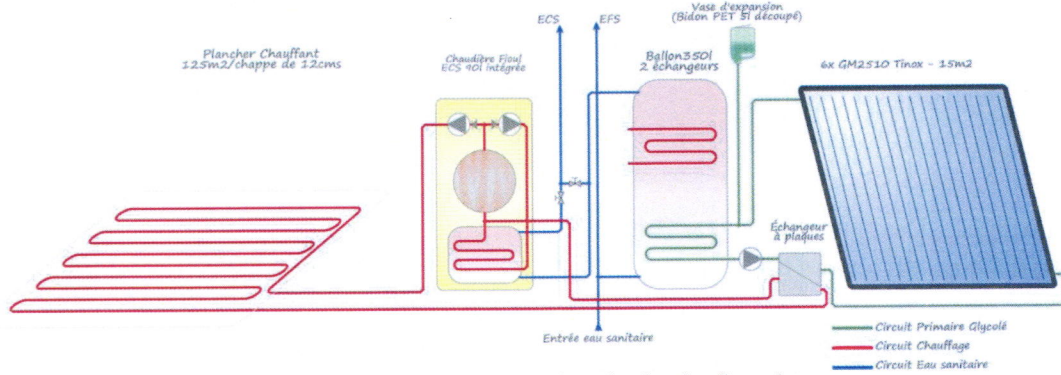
exemple d'une installation d'un plancher chauffant solaire
